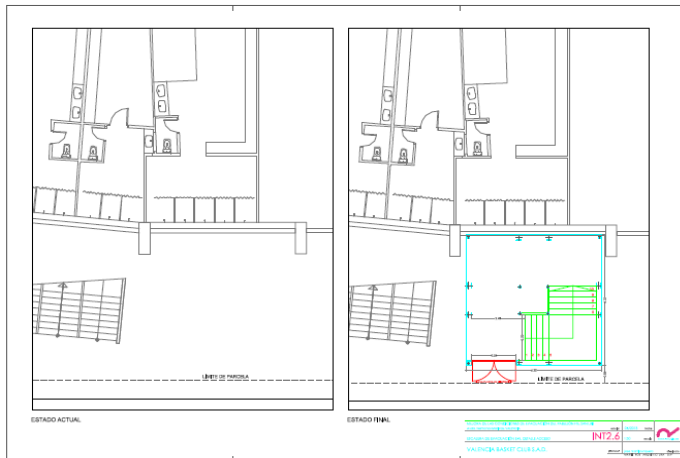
Plano detalle de Acceso a Escalera E-N. Plano 19.
